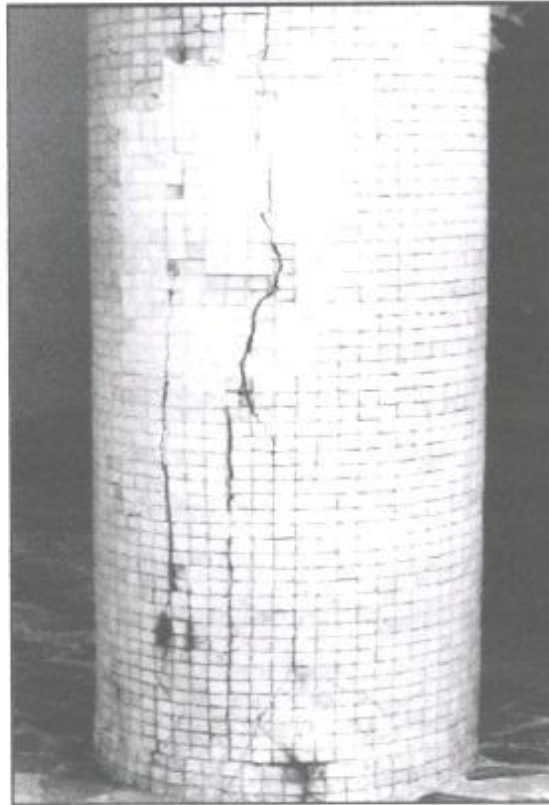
Estructura de hormigón armado cuyas barras de acero se han oxidado.
